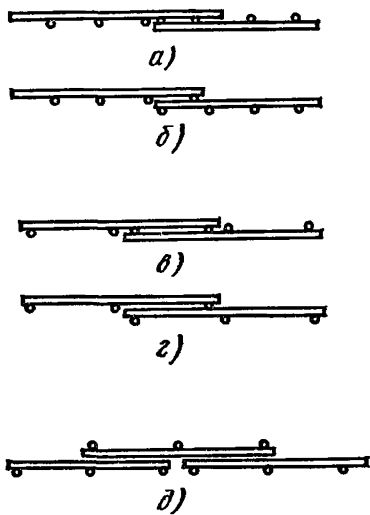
Налесточные соединения сеток без сварки в направлении распределительной арматуры: а, б — при диаметре распределительной арматуры до 4 мм включительно, в, г — при диаметре распределительной арматуры более 4 мм, д — при диаметре рабочей арматуры 16 мм и более
